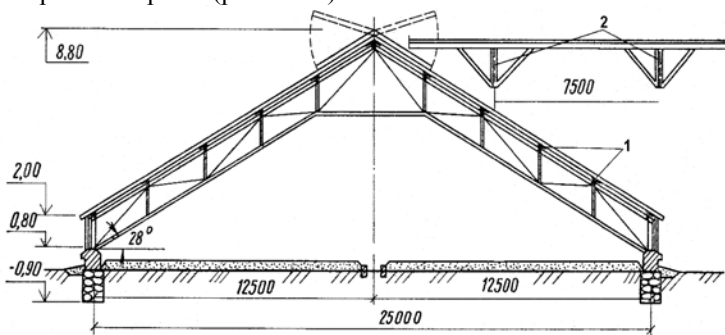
Поперечний переріз ангарної теплиці з несучою конструкцією у вигляді арочної ферми із кутиків:
